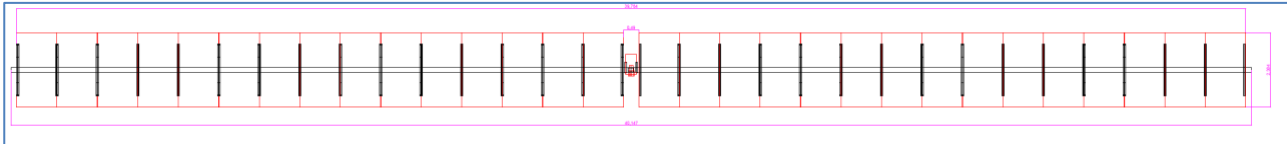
Dimensioni indicative in pianta dei tracker fotovoltaici previsti a progetto
